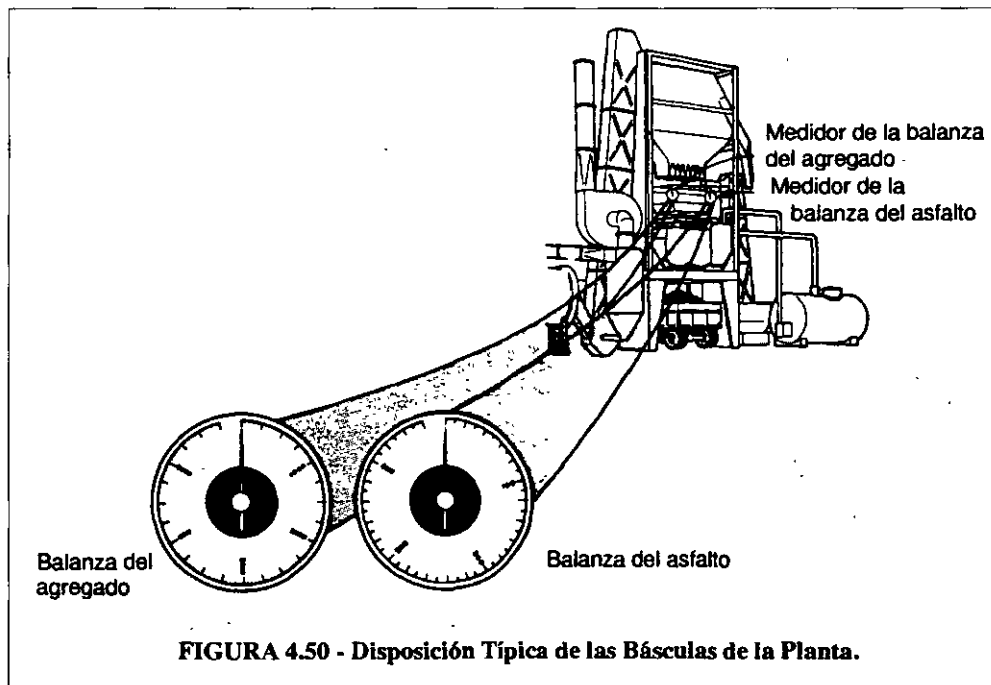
Disposición Típica de las Básculas de la Planta.
